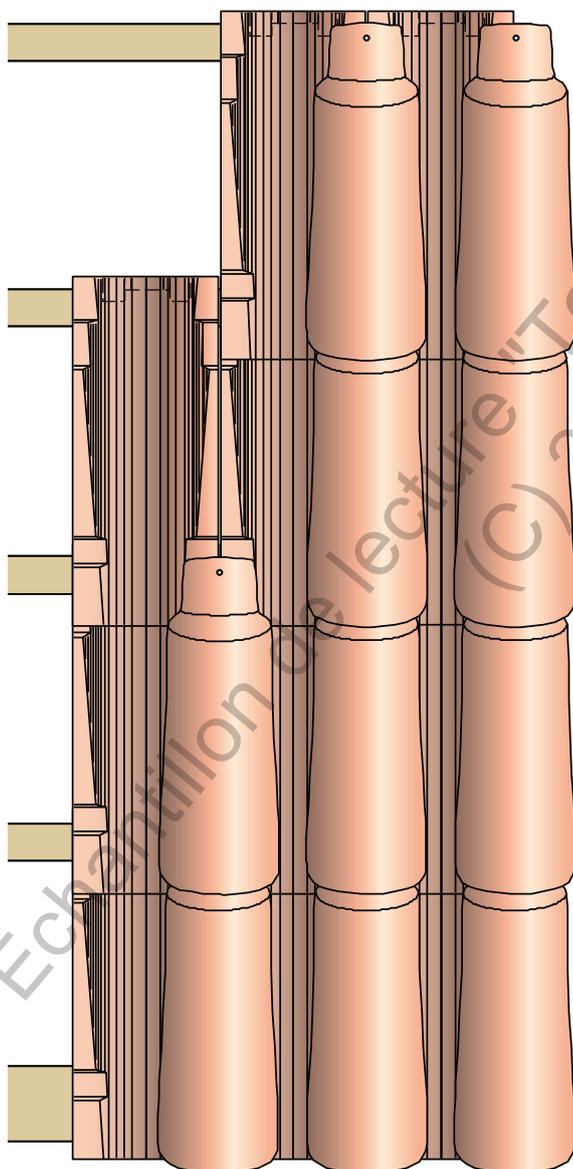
/401: Couverture en tuiles de couvent formées à la presse
